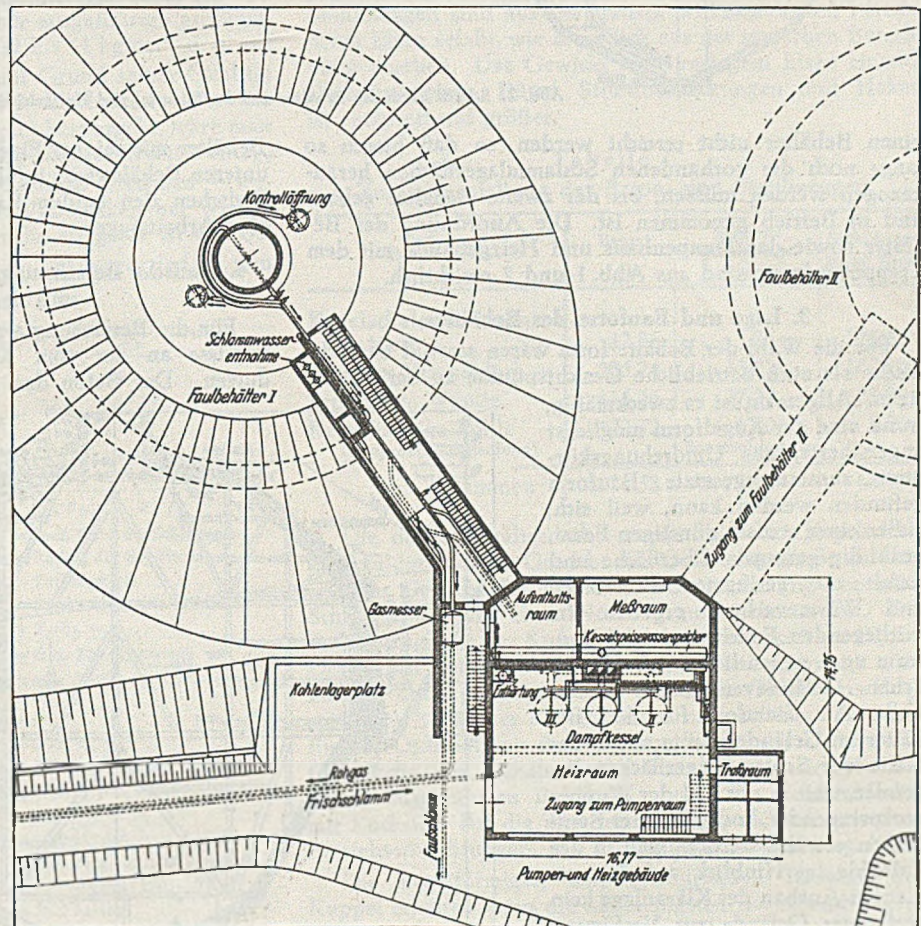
Stahlbeton-Faulbehälter von je 6100 m<sup>3</sup> Inhalt mit Pumpen- und Heizgebäude und Treppenaufgang.
